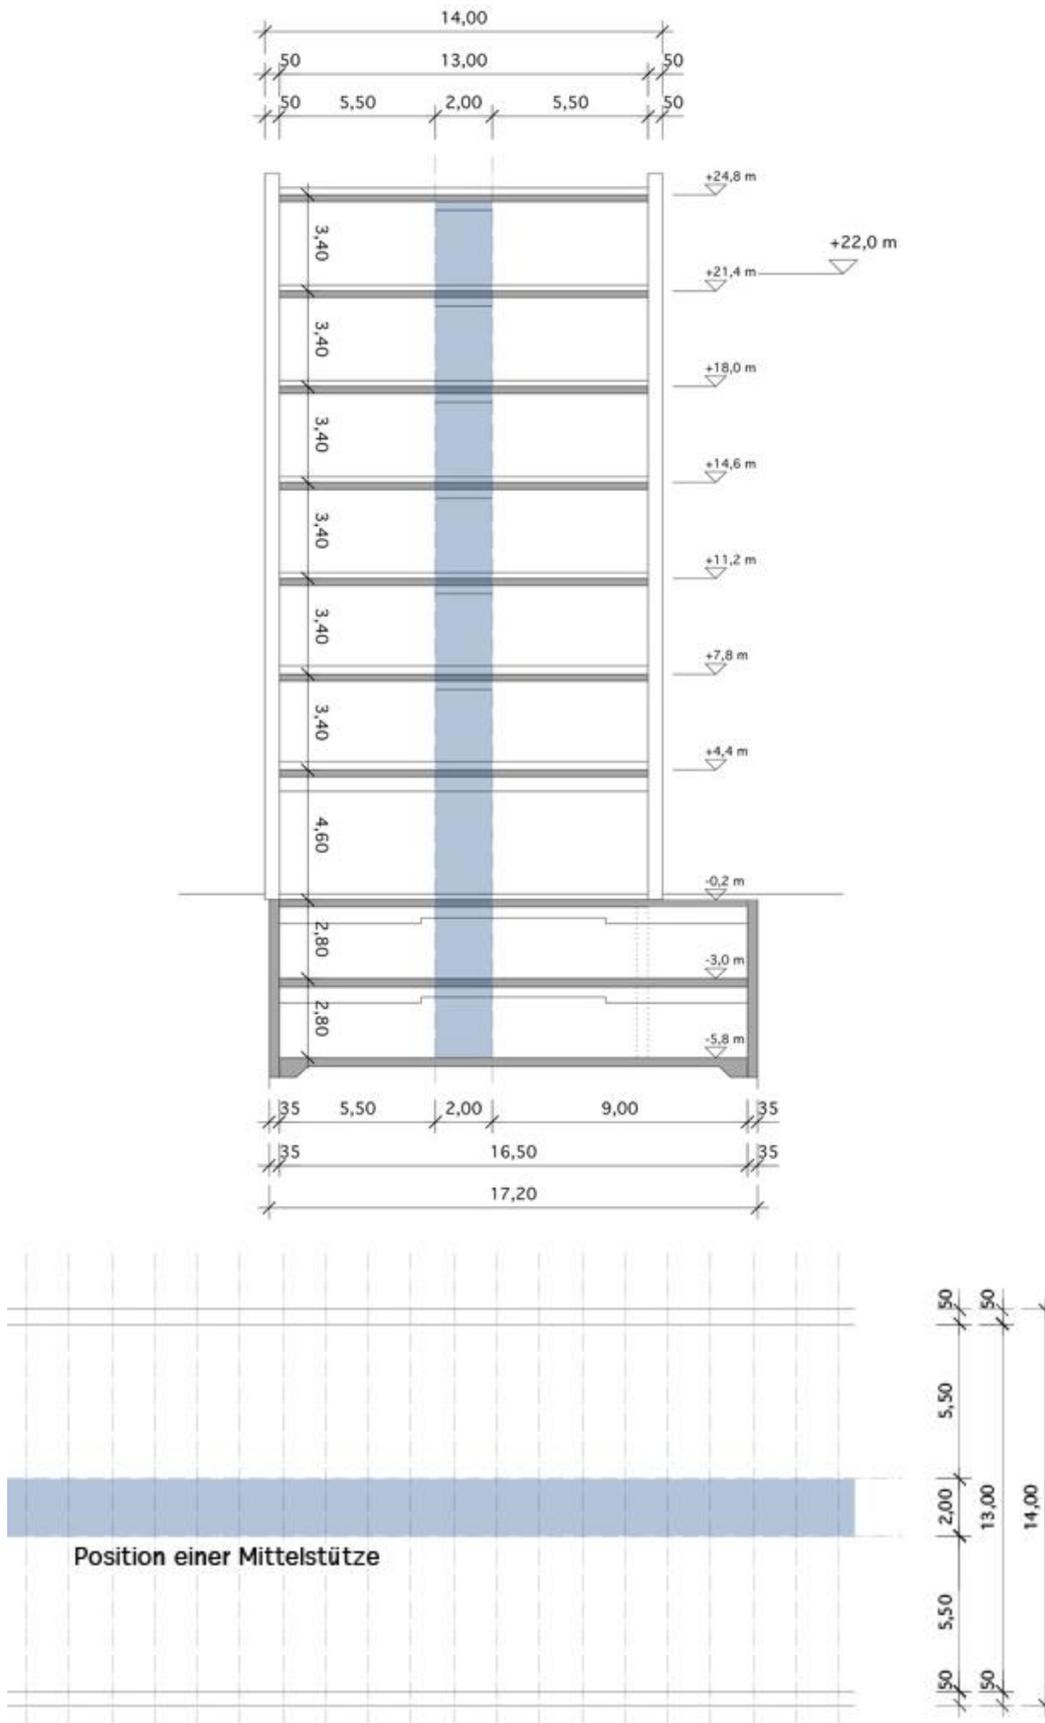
Kompatible Geschossstruktur in Schnitt und Grundriss
